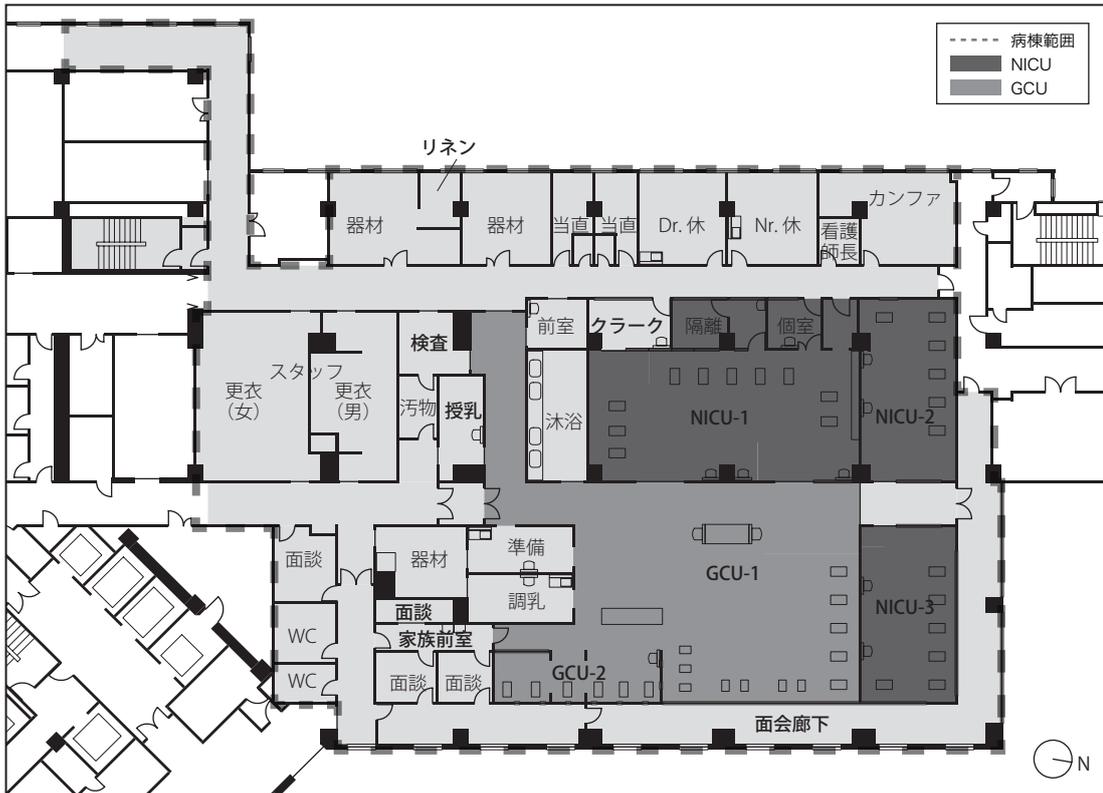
SI 病院の新生児病棟平面図 (S=1/400)
